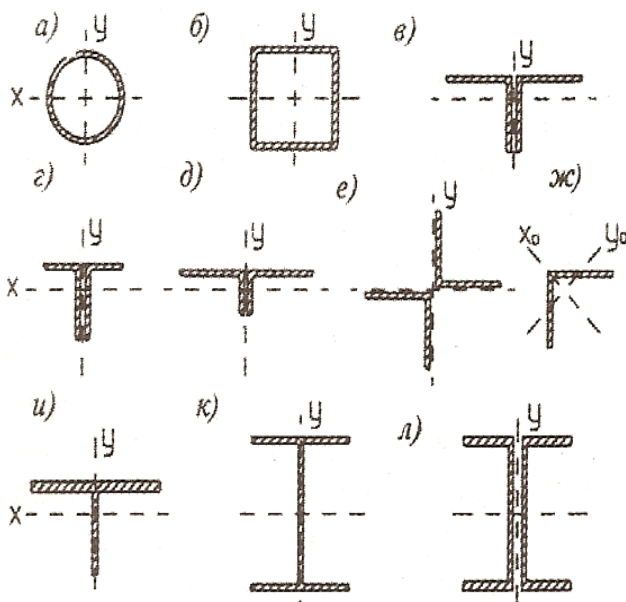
Типы сечений стальных ферм: *а* – трубчатое; *б* – прямоугольное гнутозамкнутое; *в, г, д, е* – из парных уголков; *ж* – из одиночных уголков; *и* – из тавров – для поясов ферм; *к, л* – то же, из двутавра или двух швеллеров
